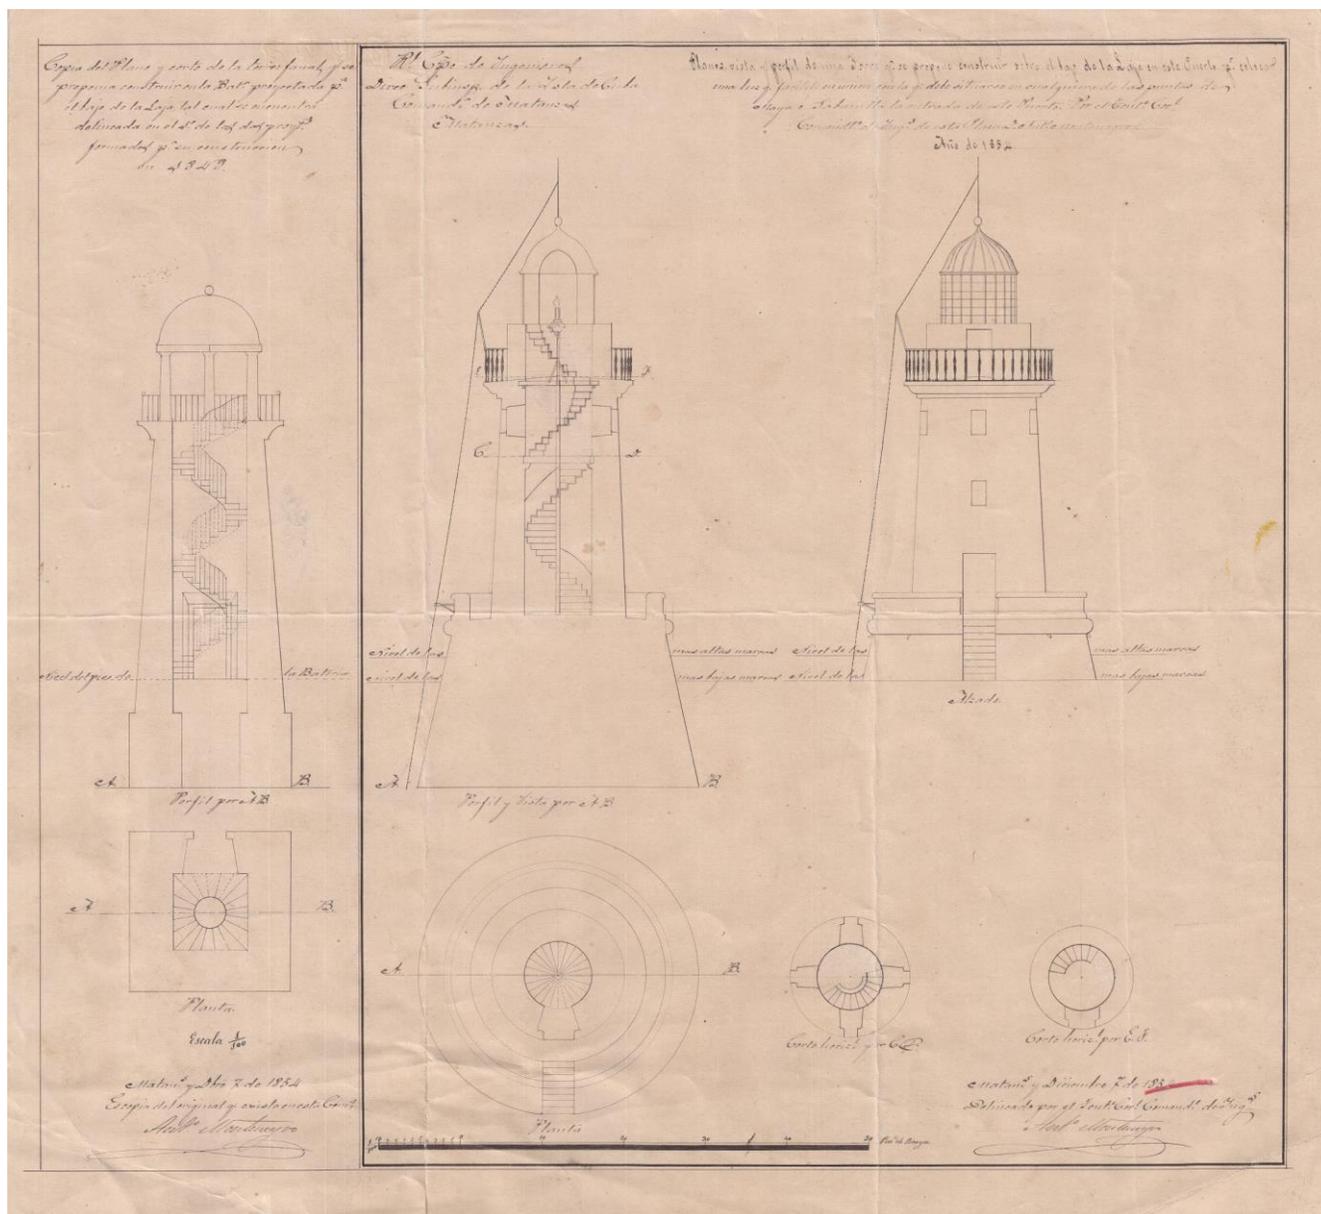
Planos, vista y perfil de una torre (faro) que se propone construir sobre el bajo de la Laja en este puerto para colocar una luz que facilite en unión con la que debe situarse en cualquiera de las puntas de Maya ó Sabanilla la entrada de este puerto. Copia del plano y corte de la torre fanal que se proponía construir en la batería proyectada para el bajo de la Laja, tal cual se encuentra delineada en el 1º de los dos proyectos formados para su construcción en 1848 (1854). AGM, CUB-60-16
